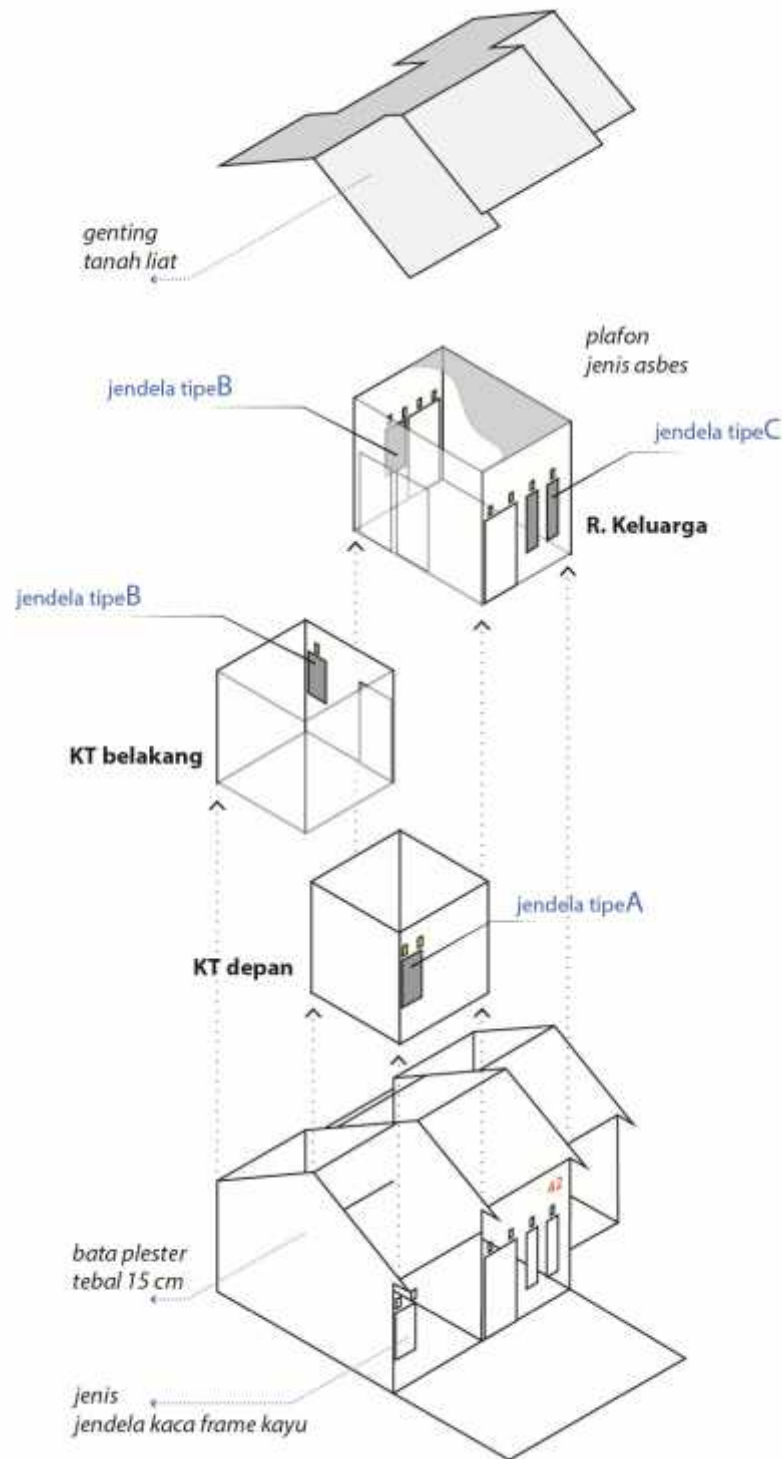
Denah dan potongan rumah (objek penelitian)
